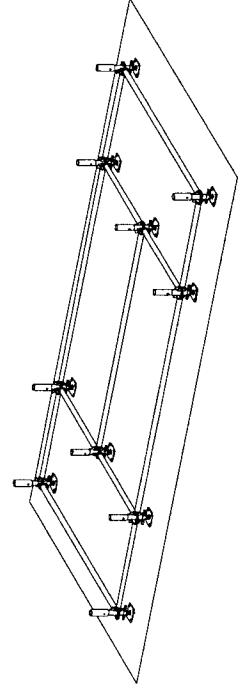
Grundrahmen des Bautreppenturms
